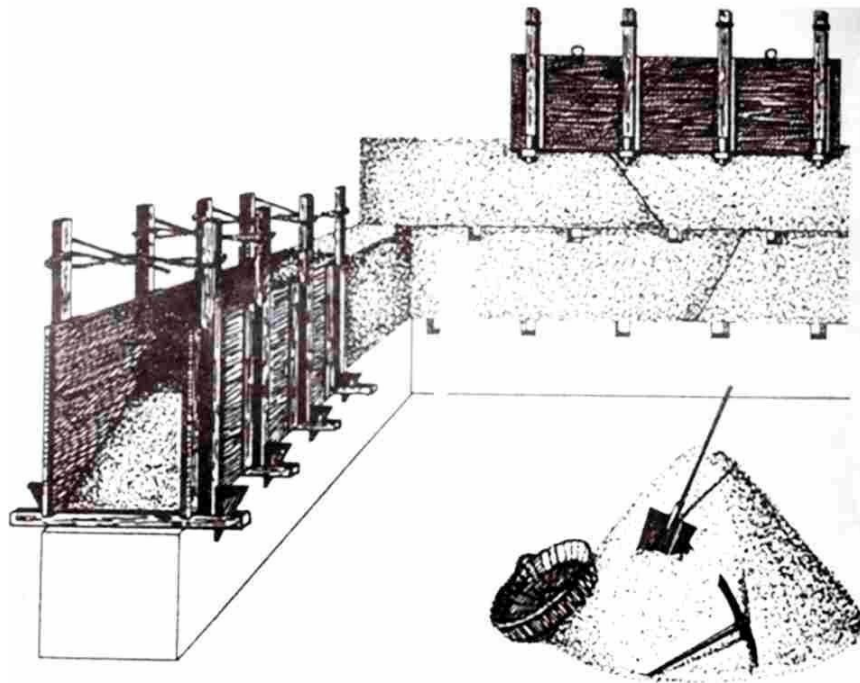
Proceso constructivo de muros de tapia pisada. Fuente: Construcción de muros en tapia y bahareque. SENA.
